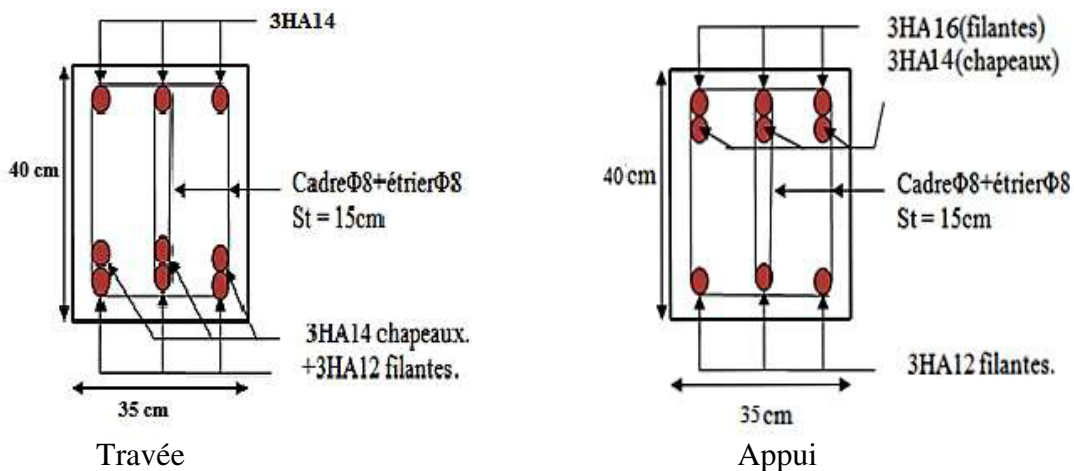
Schéma de ferrailage des poutres principales de la terrasse.
